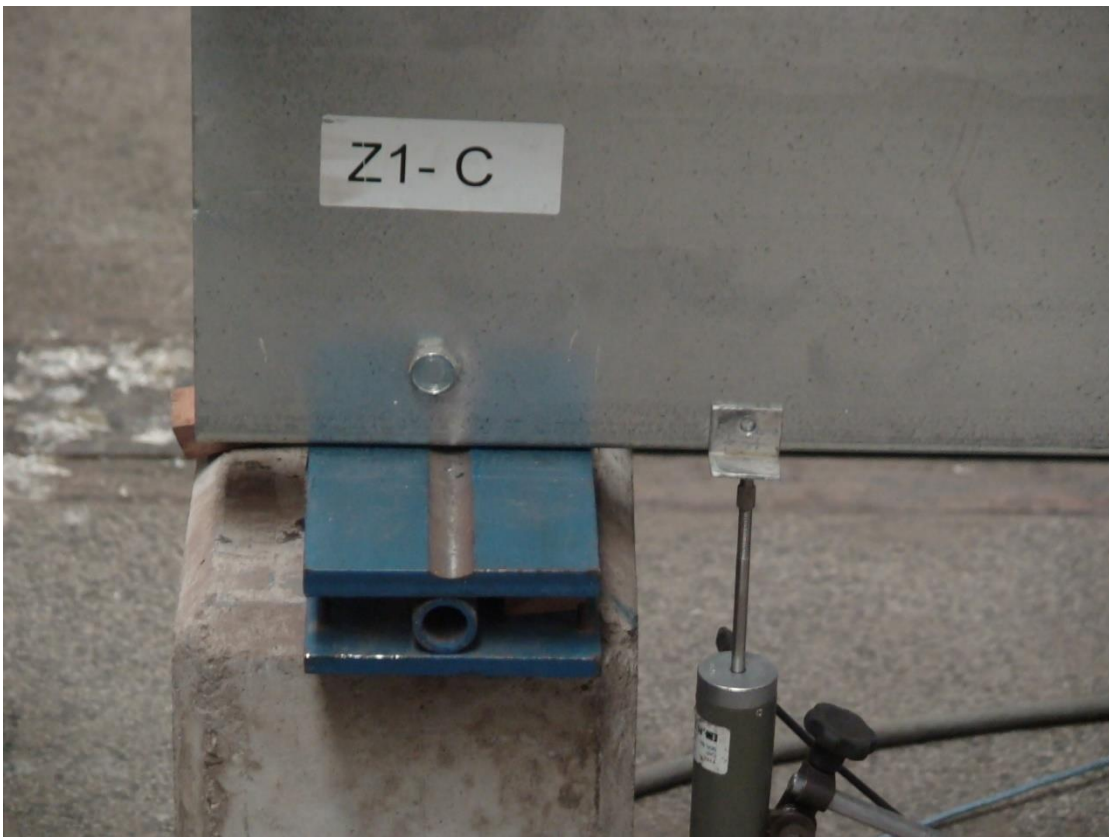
Detalhe do aparelho de apoio e do transdutor de apoio.
